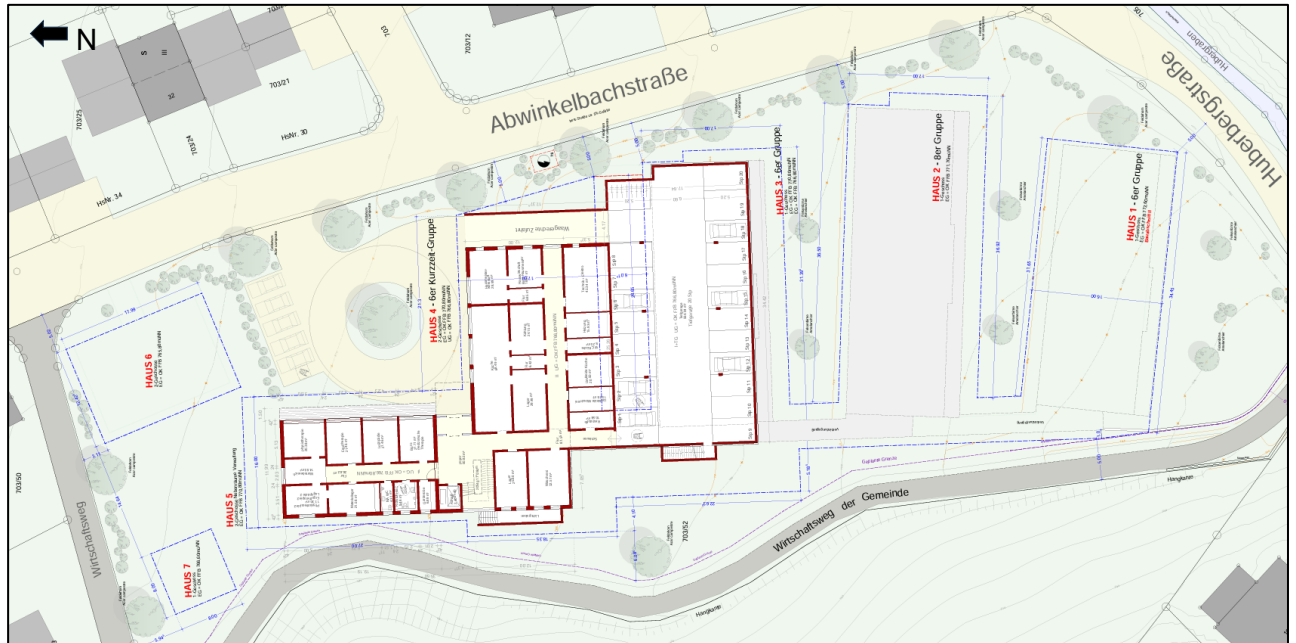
Ausschnitt aus [5]: Lageplan/Grundrisse Vorentwurf 8
